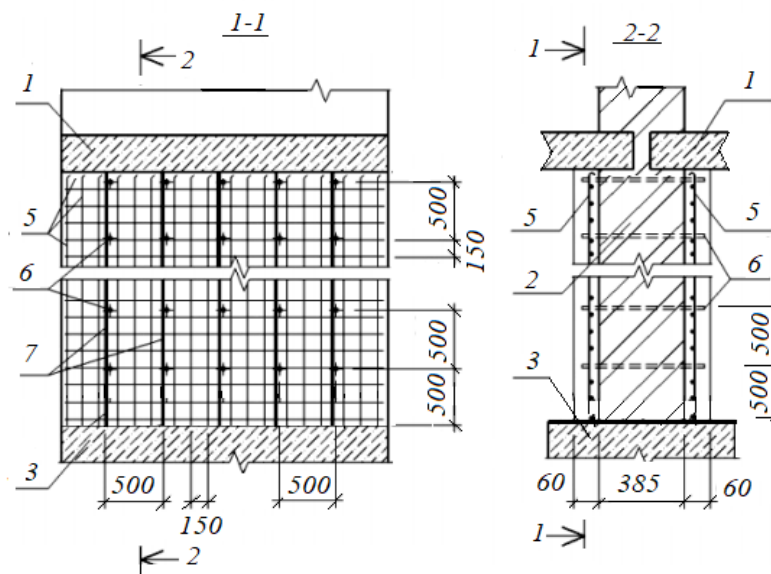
Усиление набетонкой: 1 – плита перекрытия; 2 – усиливаемая стена; 3 – фундамент; 4 – набетонки класса В12.5; 5 – стальная сетка $\varnothing 5$ мм с ячейкой 150×150 мм; 6 – поперечные связи $\varnothing 16$ мм через 500 мм; 7 – вертикальная арматура $2\varnothing 16$ мм через 500 мм
